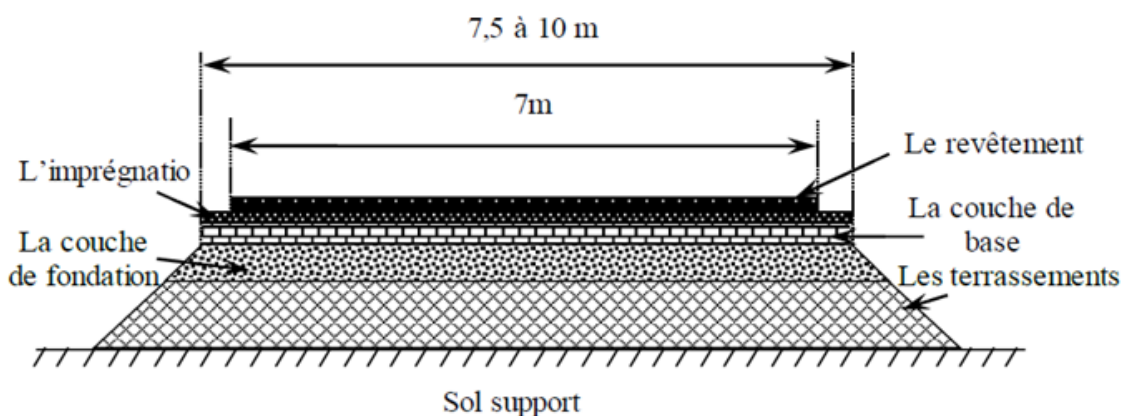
Profil type d'une chaussée et terminologie des différentes couches.
